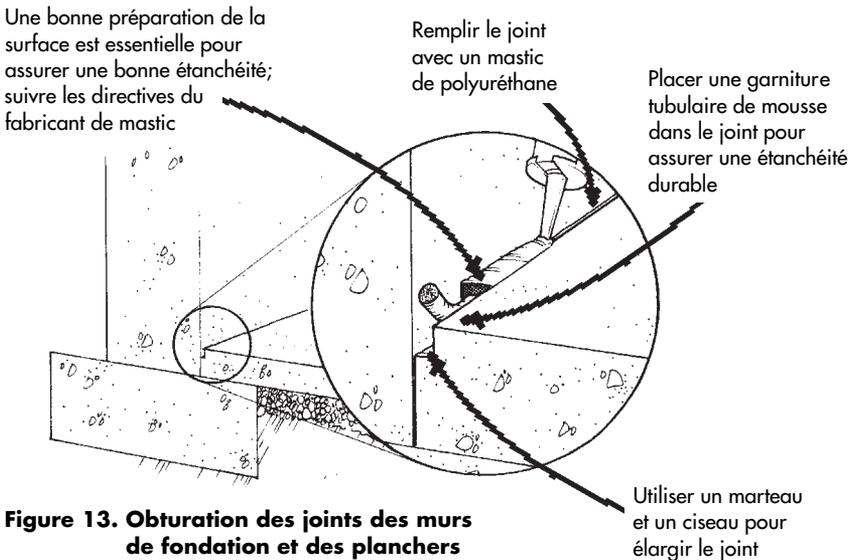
Obturation des joints des murs de fondation et des planchers du sous-sol
